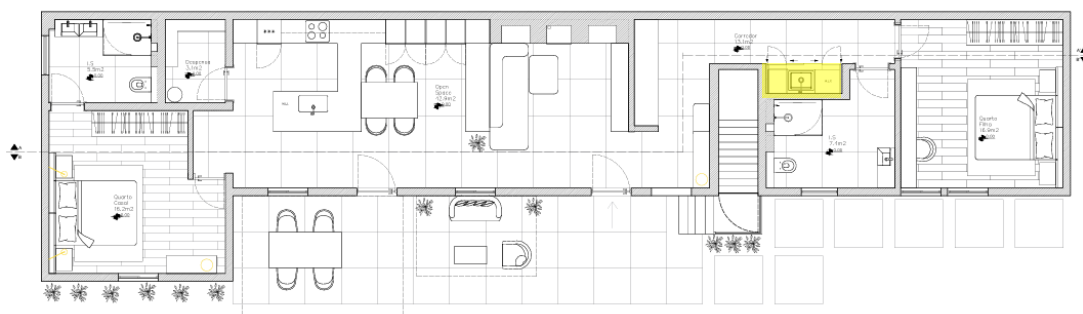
Planta de apresentação zona da lavandaria Fonte: Autor
